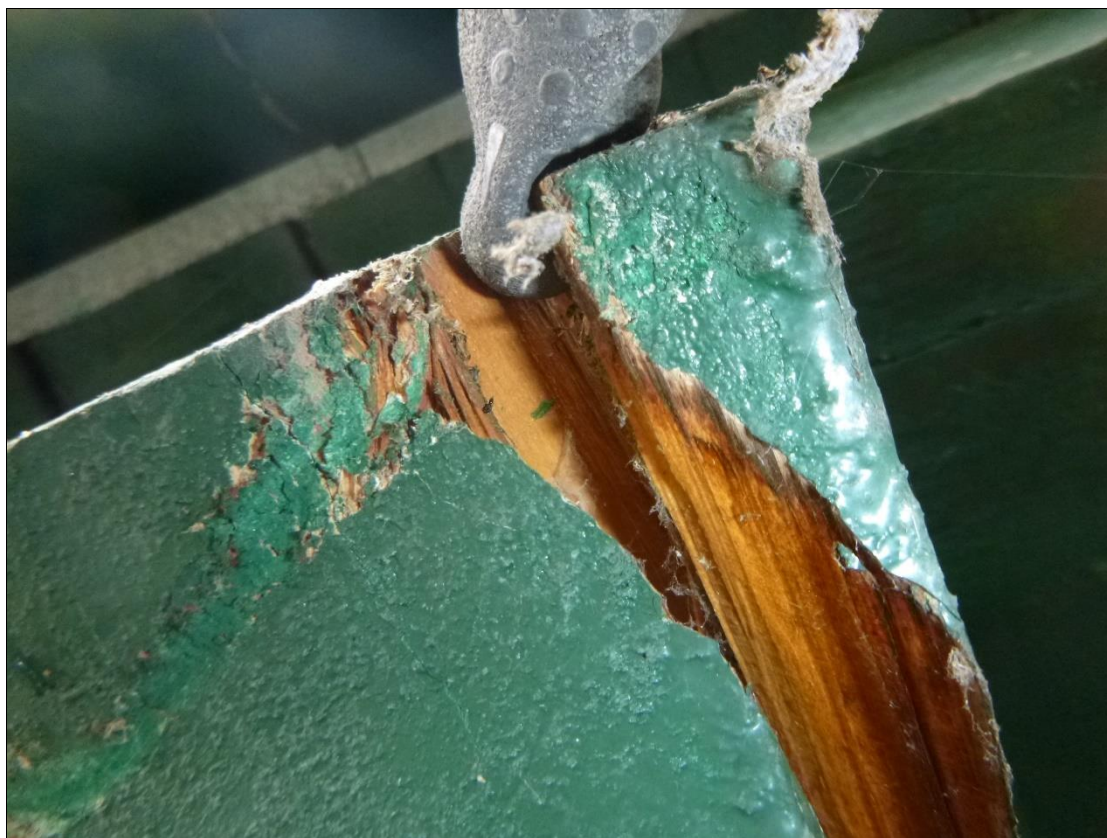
Vnější sopouch E-F F – degradace dřeva zatékáním (detail)
